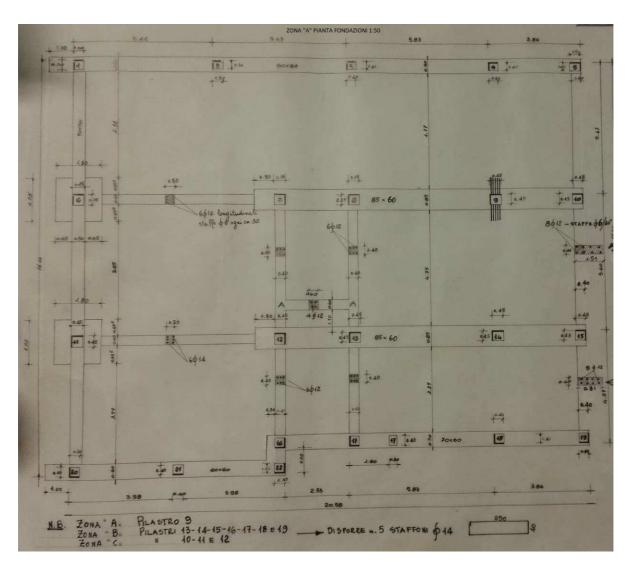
Stralcio del progetto esecutivo reperito Padiglione n.16. – Pianta fondazioni Zona A
